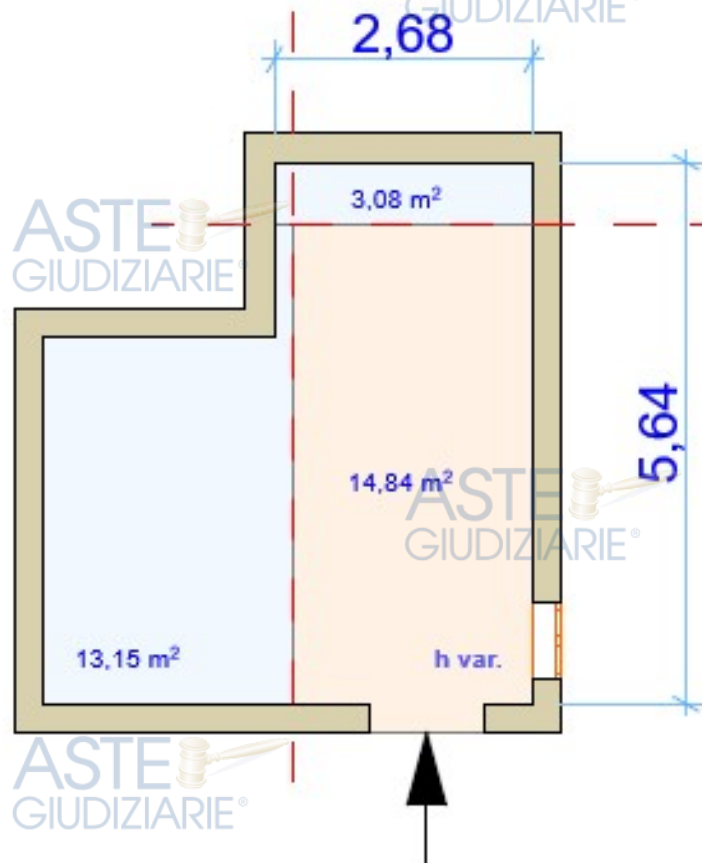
Planimetria di rilievo magazzino a piano terra – in arancio la superficie oggetto di condono in azzurro l'ampliamento abusivo.
